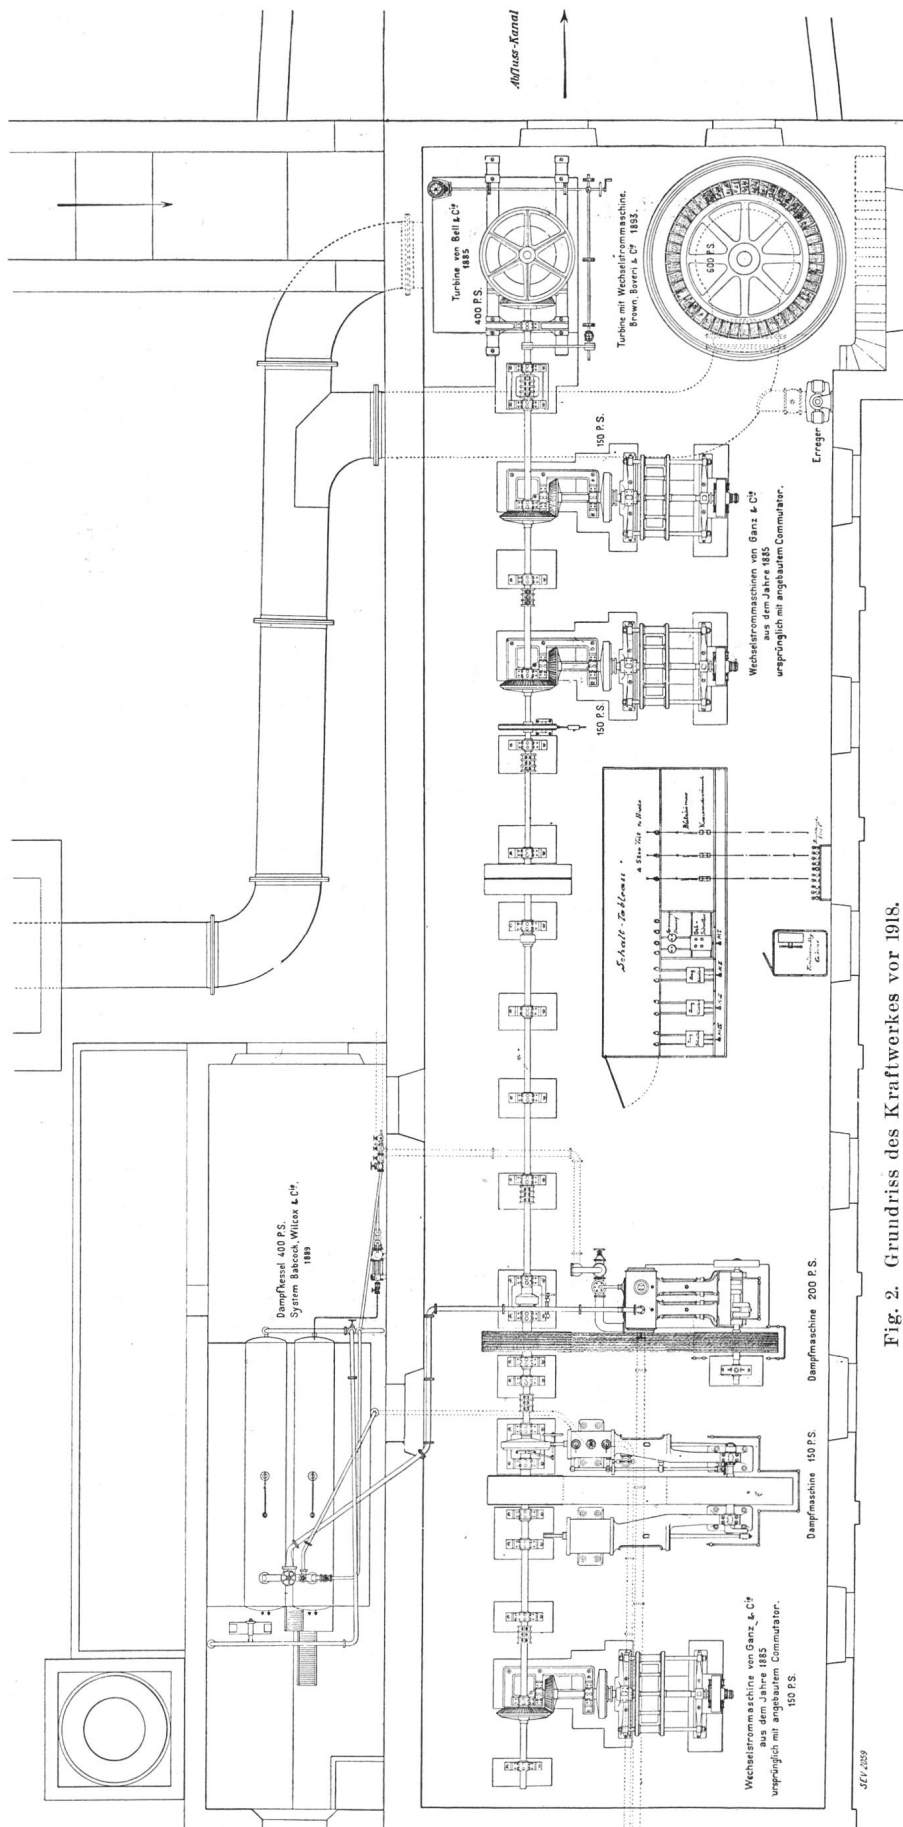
Grundriss des Kraftwerkes vor 1918.
